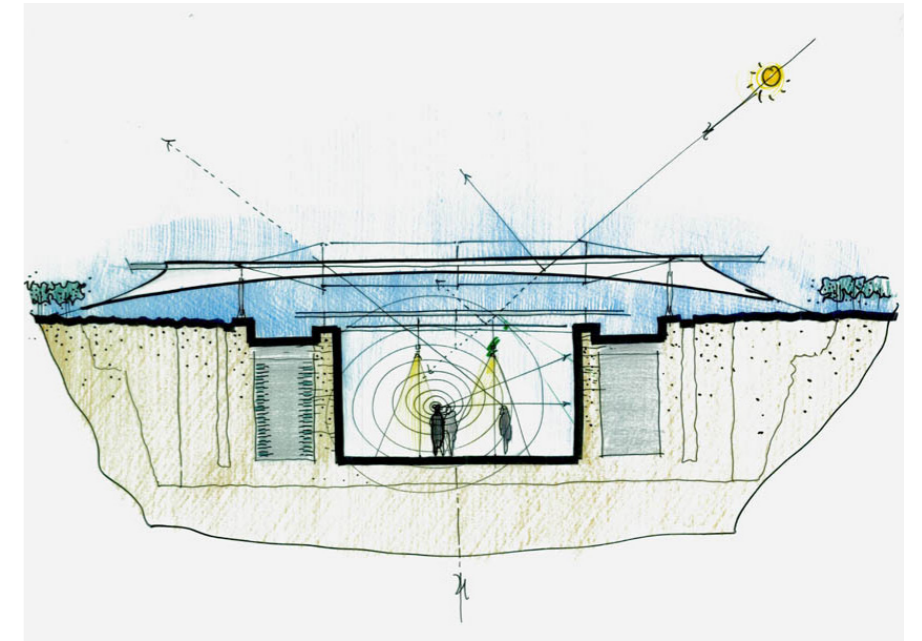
Croquis en sección Building Workshop, Renzo Piano.
